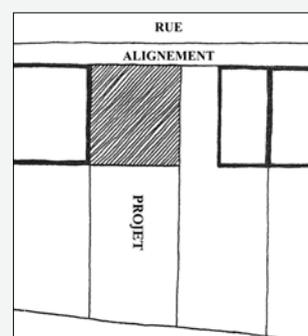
B : projet conforme d'une construction implantée contre la limite mitoyenne.
